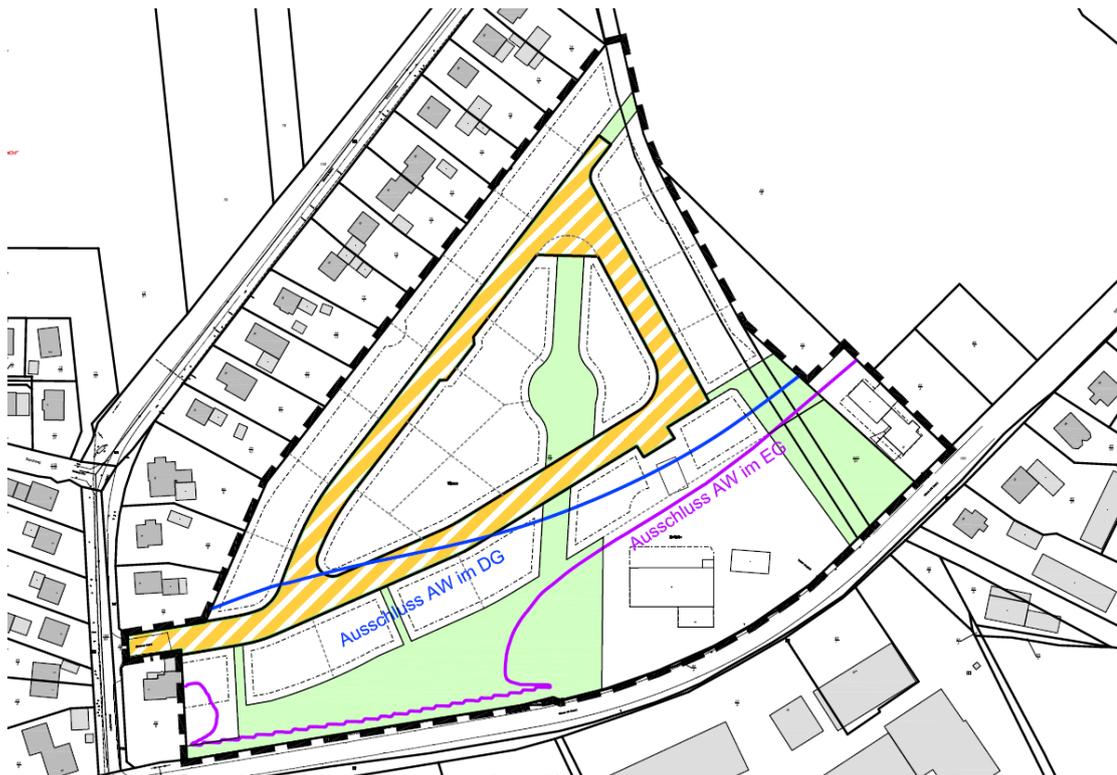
Lageplan Ausschluss von Außenwohnbereichen (AW) im Erd- (EG) und Dachgeschoss (DG)
